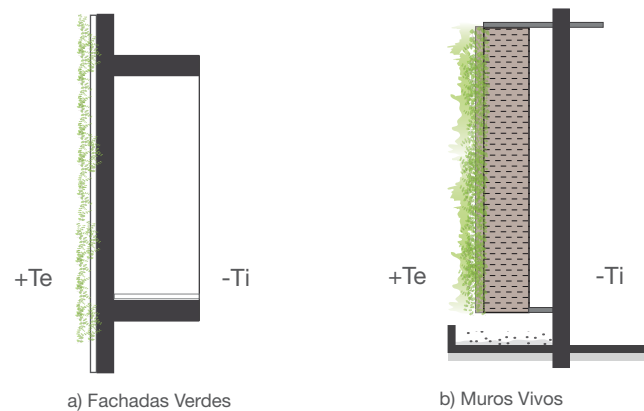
Tipo de paredes verdes: fachada verde y muros vivos (elaborado por autores).
